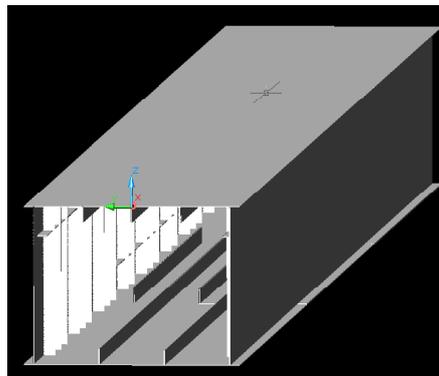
box girder のモデリング 図 - 5 plate girders のモデリング
